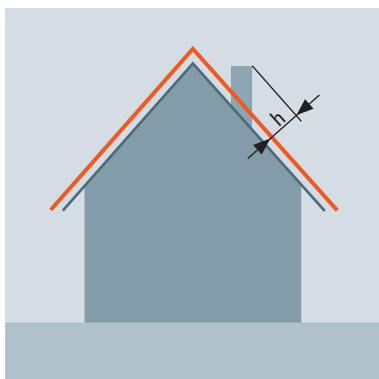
Altezza della struttura sul tetto di materiale non conduttivo (ad es. PVC), $h \leq 0,5$ m
